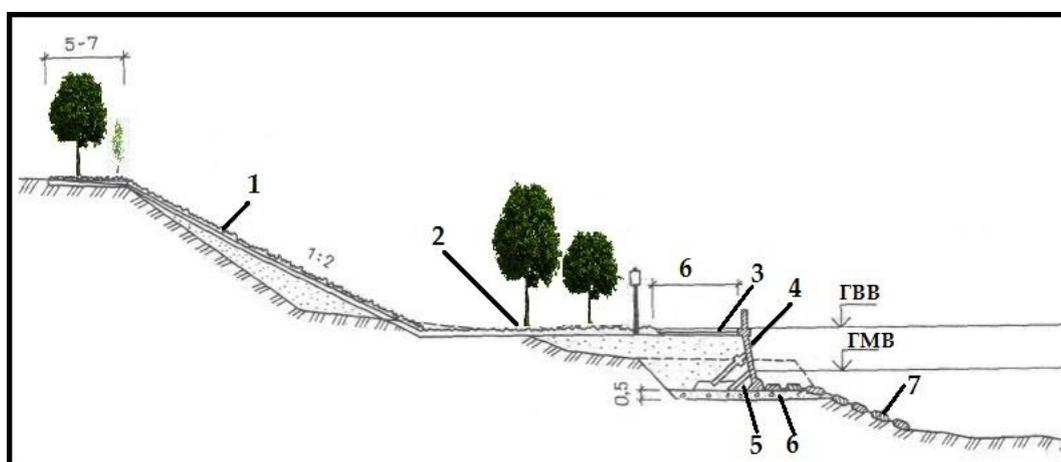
Набережная с вертикальной стенкой (вариант): 1 — крепление дерном; 2 — зеленый газон; 3 — монолитные бетонные плиты покрытия прогулочной аллеи; 4 — сборная железобетонная подпорная стенка; 5 — обратный фильтр; 6 — карьерная мелочь; 7 — гибкий железобетонный тюфяк высотой 20 см. ГВВ – горизонт высоких вод; ГМВ – горизонт меженных вод.
